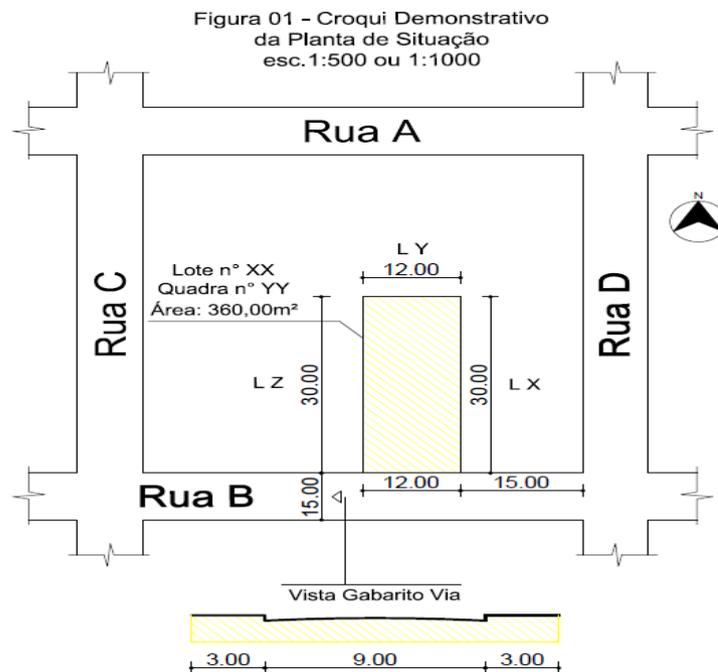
Croqui demonstrativo da planta de situação (para construção e legalização)
